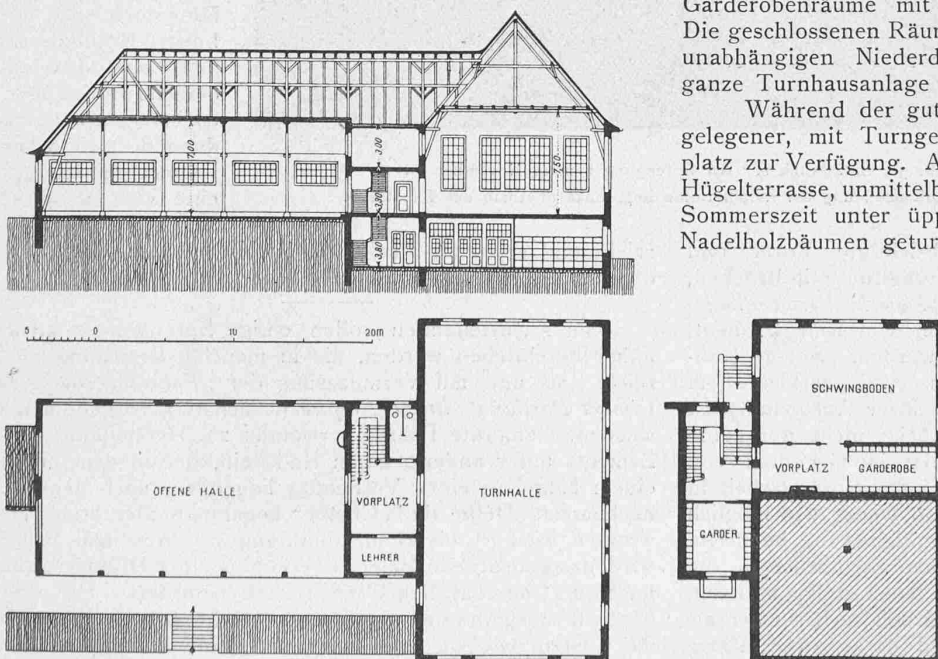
bis 11. Grundrisse und Längsschnitt durch das Turnhaus Heiligberg. — 1:500.
